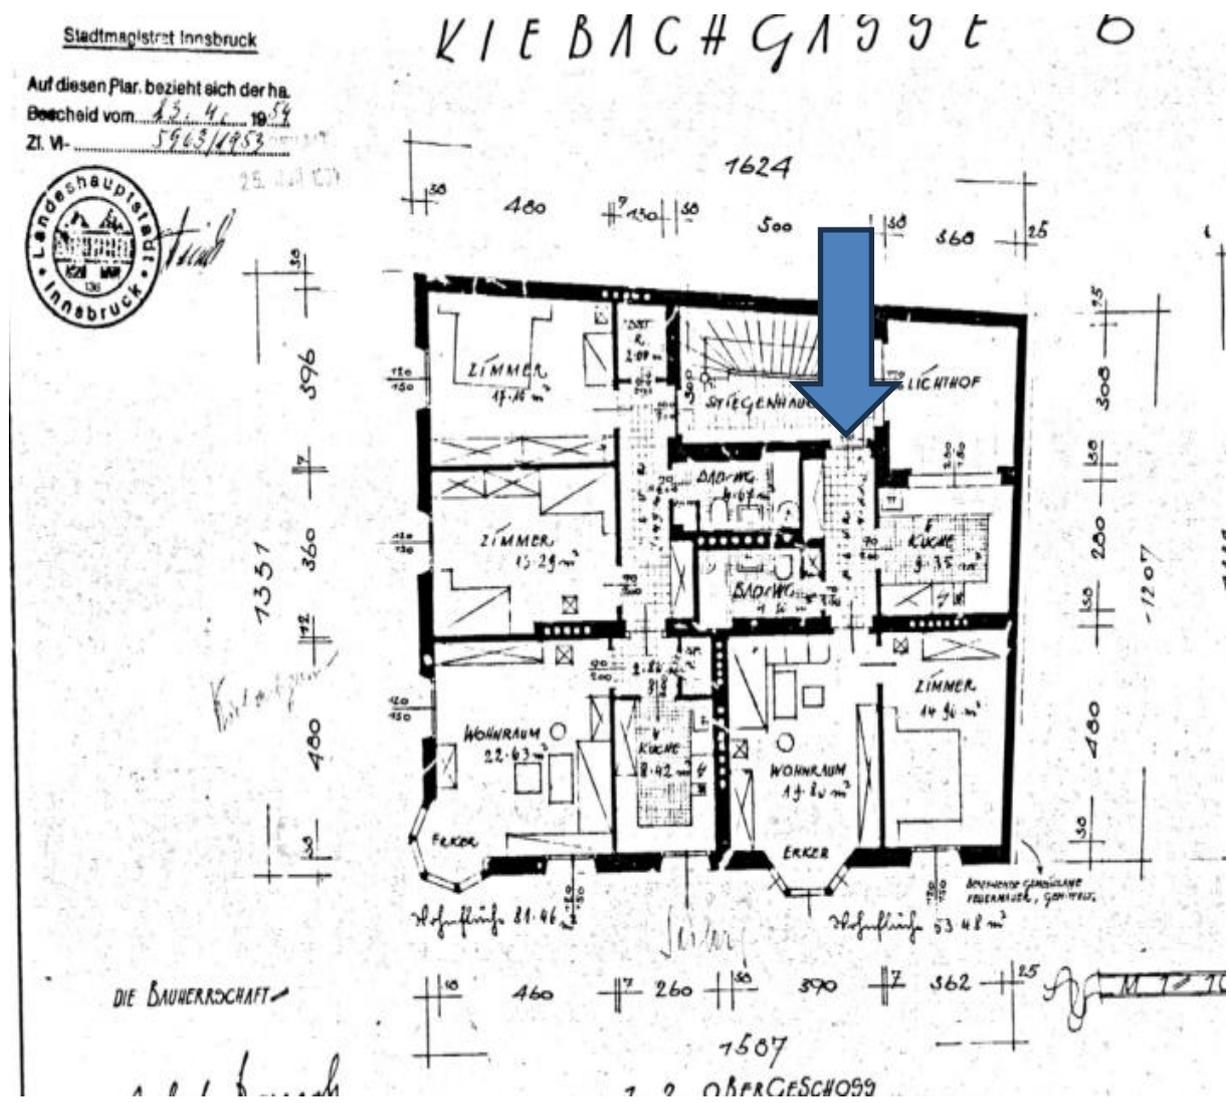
Grundriss aus Einreichplanung 2. Obergeschoß
